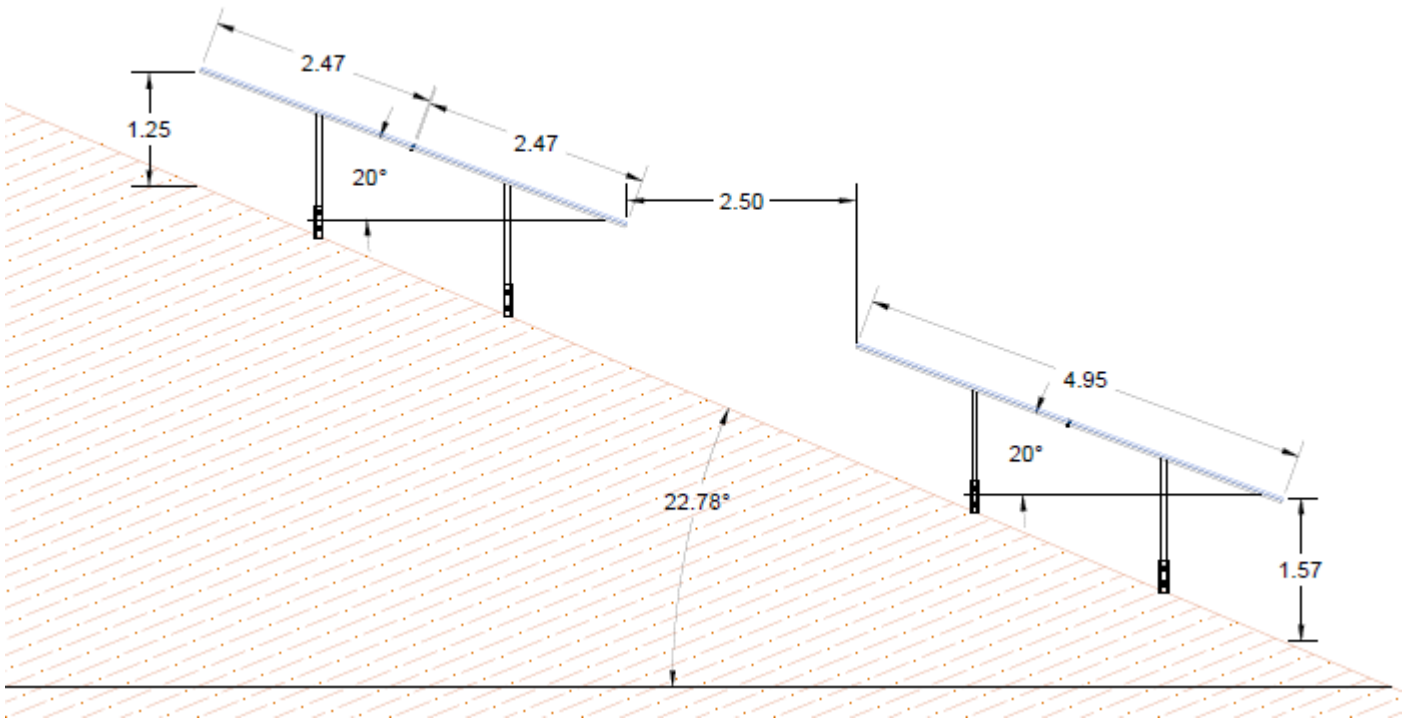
Coupe des structures porteuses prévues sur les parties en pente du site d'Armous-et-Cau (Source : CORFU Solaire)
